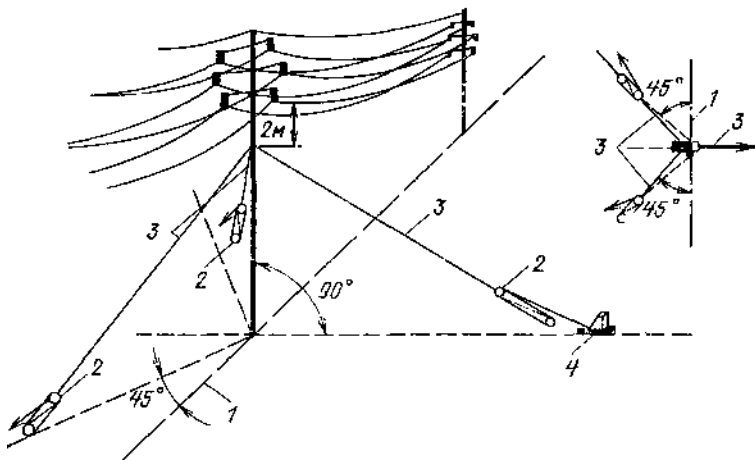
Усунення крену залізобетонної опори ПЛ:
